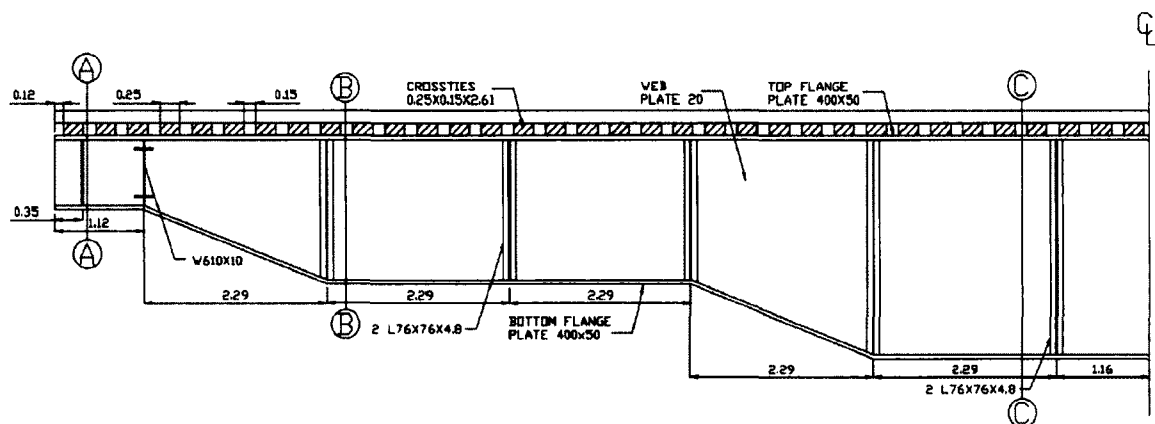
Pont bi-poutres (27,432m) - Élévation
